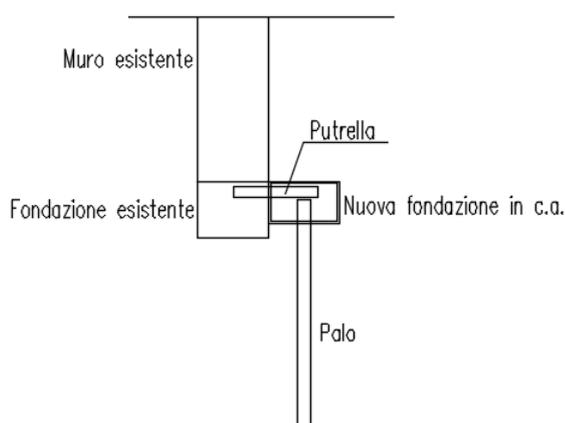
Sezione tipo del rinforzo della fondazione<sup>19</sup>
